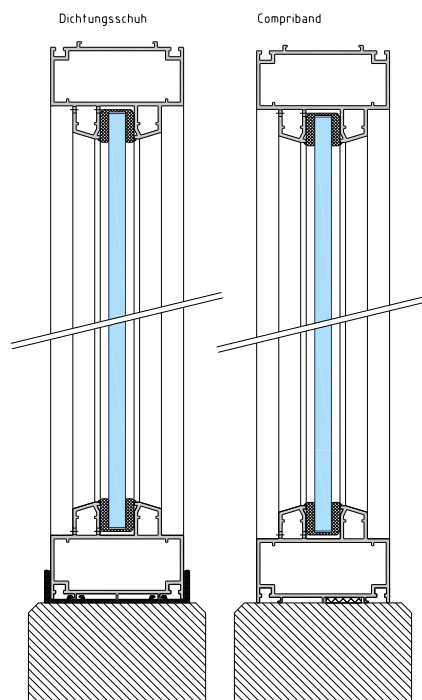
Auflagerung auf Sockelelementen aus Stahlbeton
